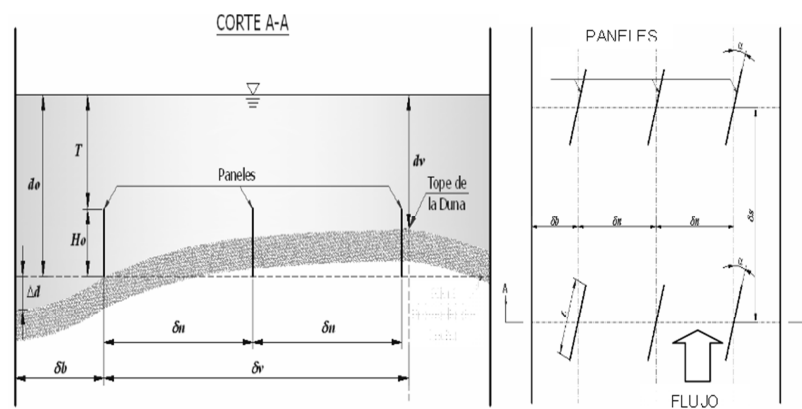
Vistas en alzado y planta de la disposición de paneles en grupos de tres, destacando los principales parámetros de diseño.
